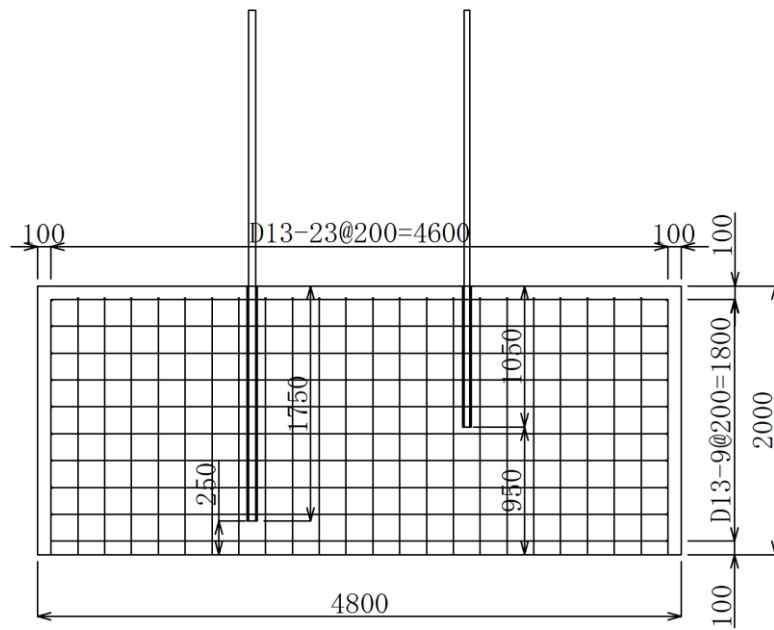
(3) 実験体①の配筋図 (B-B 断面図)
